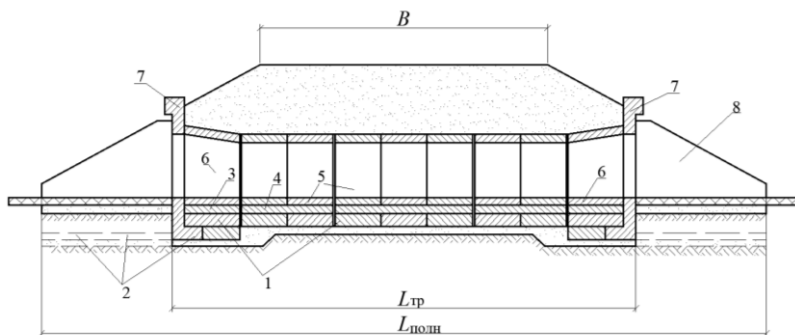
Схема круглой железобетонной водопропускной трубы:
